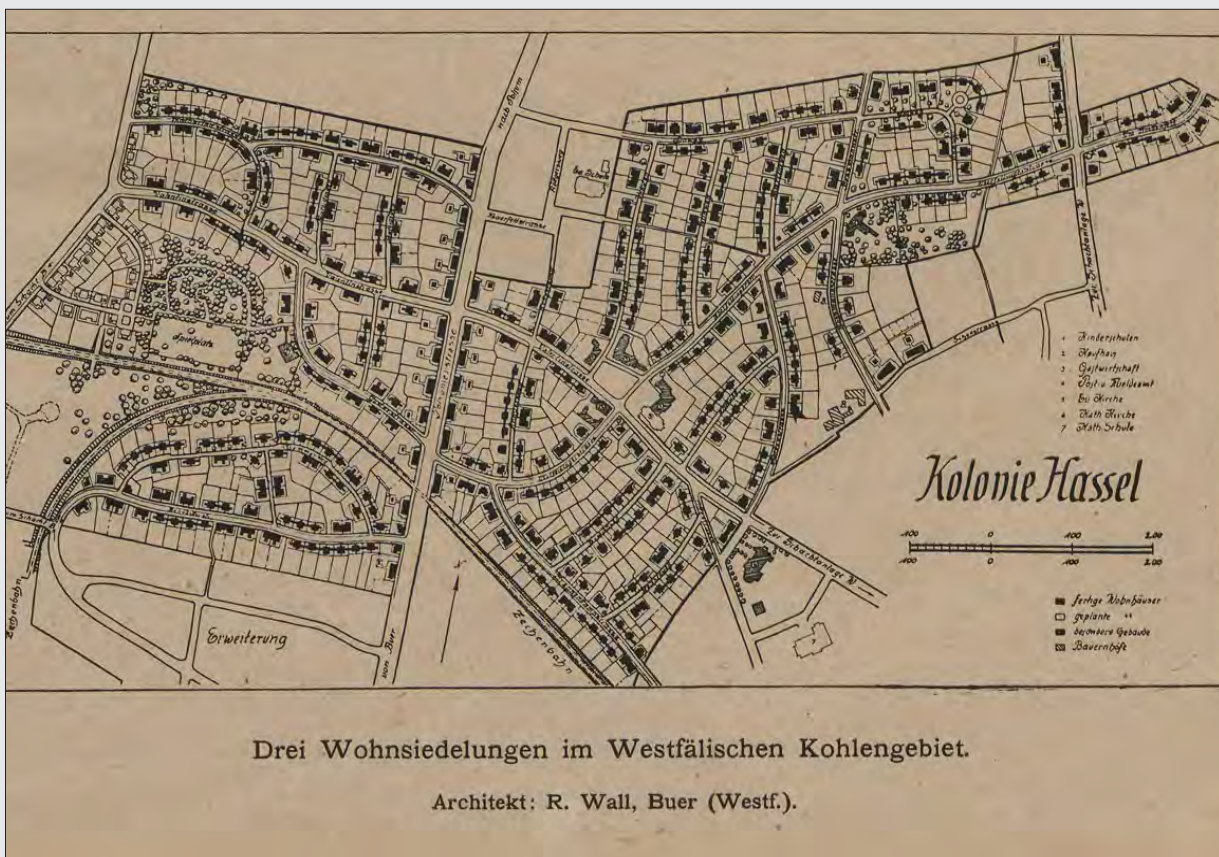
Siedlungsgrundriss der gartenstädtisch angelegten Kolonie Hassel
